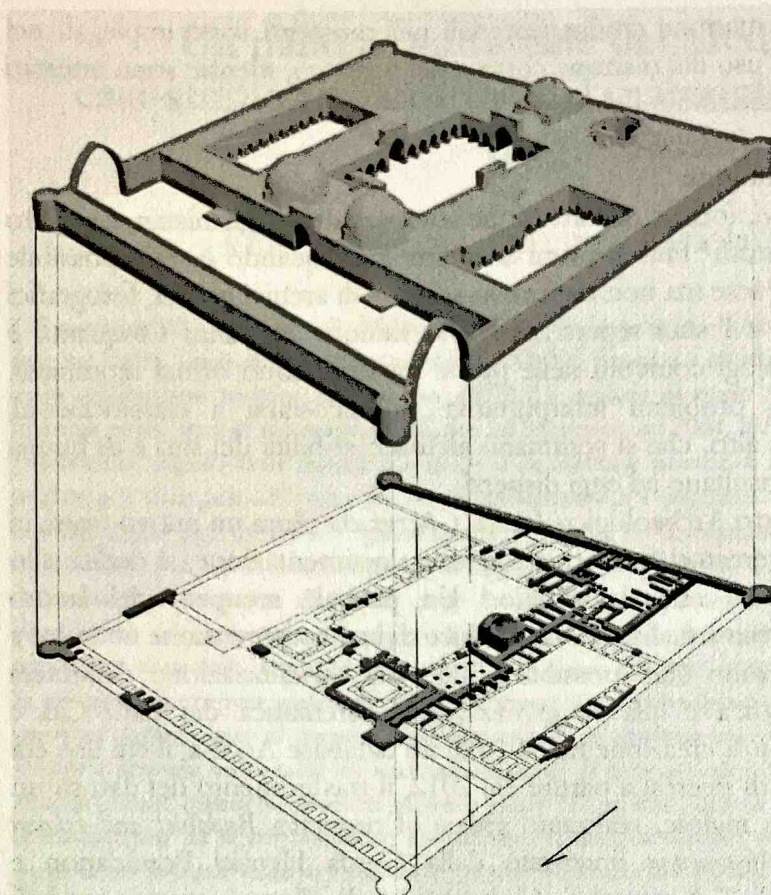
Confronto tra la pianta di scavo e la ricostruzione tridimensionale del palazzo sultaniale di Ghazni.
